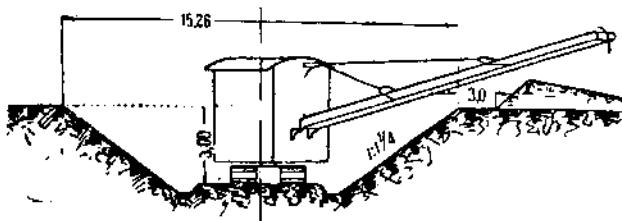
Рабочее положение фрезерного экскаватора при разработке выемки в кавальер
